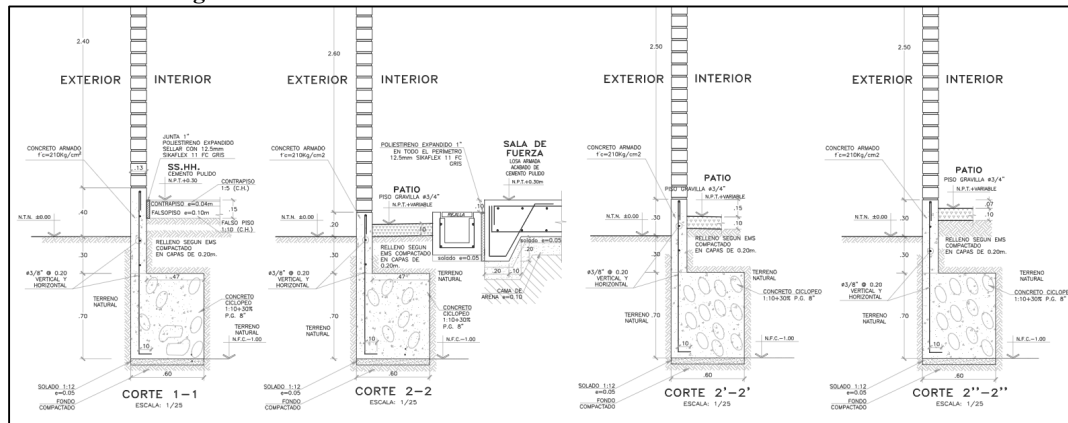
Extracto de Corte de cimentación del Plano E-02
